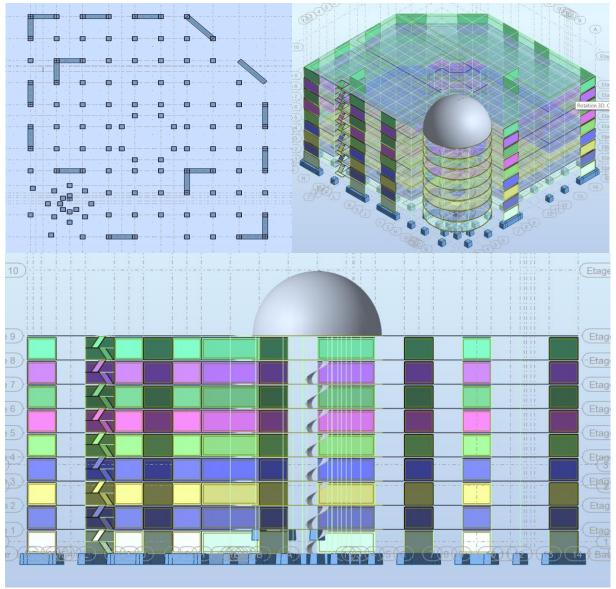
Disposition des voiles Troisième variante en 3D.
